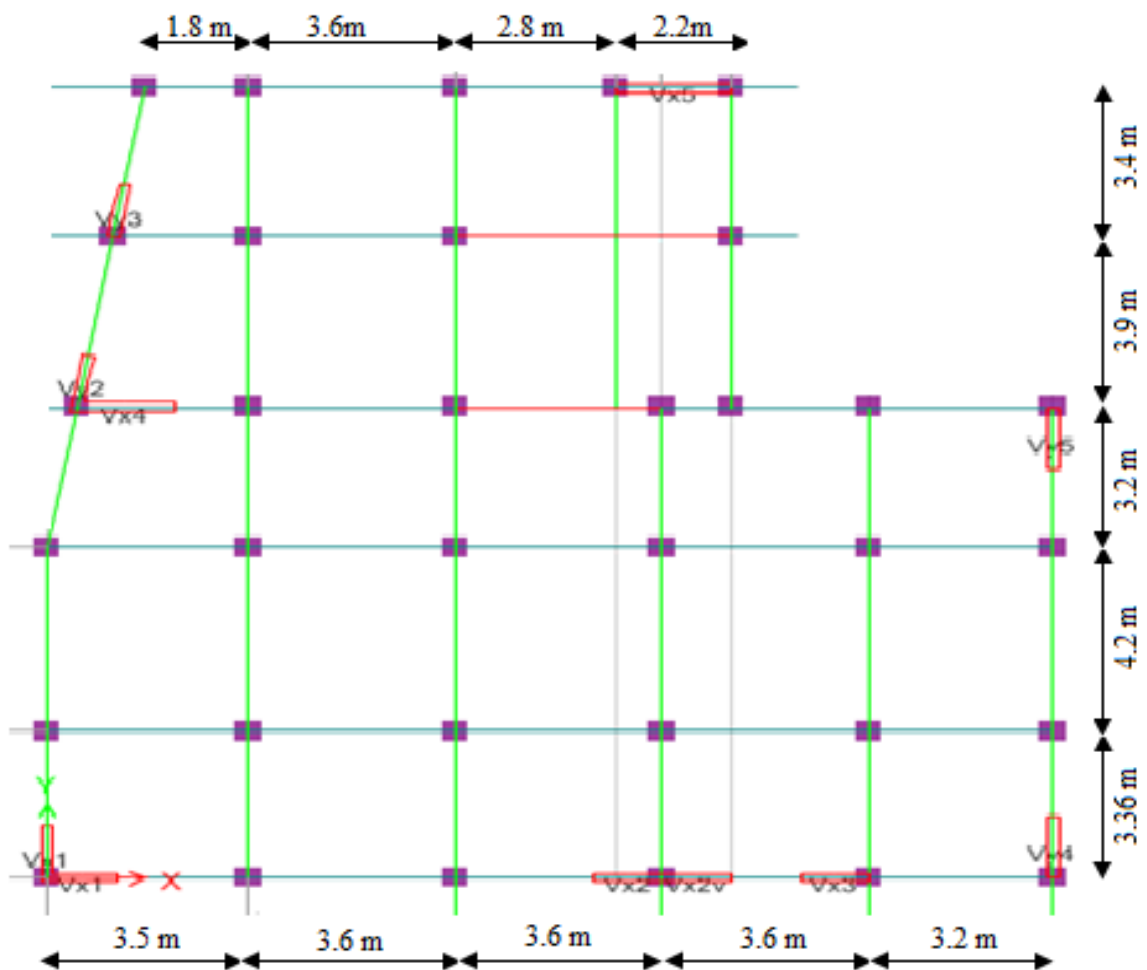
Vue en plan des éléments structuraux (Poteaux-Voiles) de la superstructure
